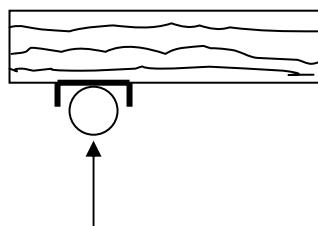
Esquema de perfil U virado com a boca para baixo, apoiado sobre o rolete e recebendo a viga de madeira
